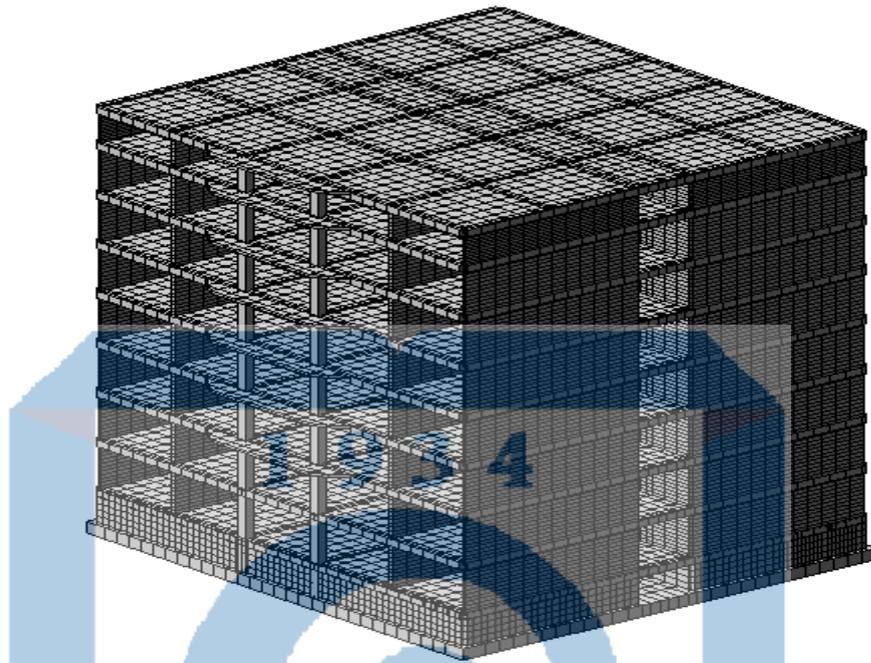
Расчетная схема здания в 3D в пространстве
